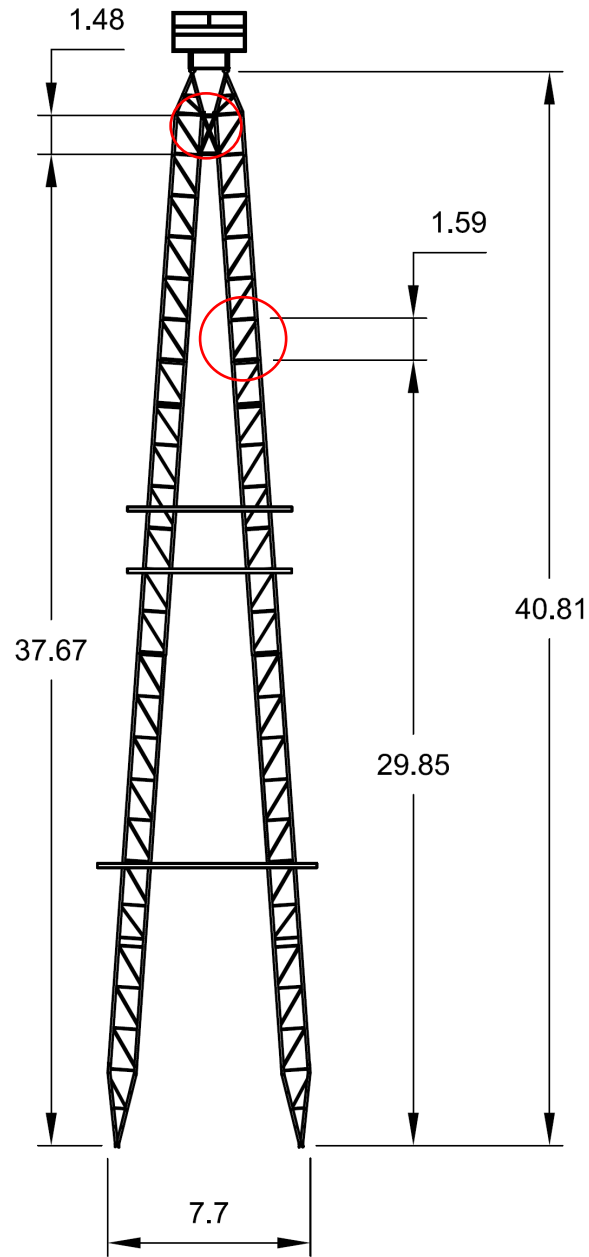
Ubicación de las zonas colapsadas con respecto al mástil (cotas en metros).
